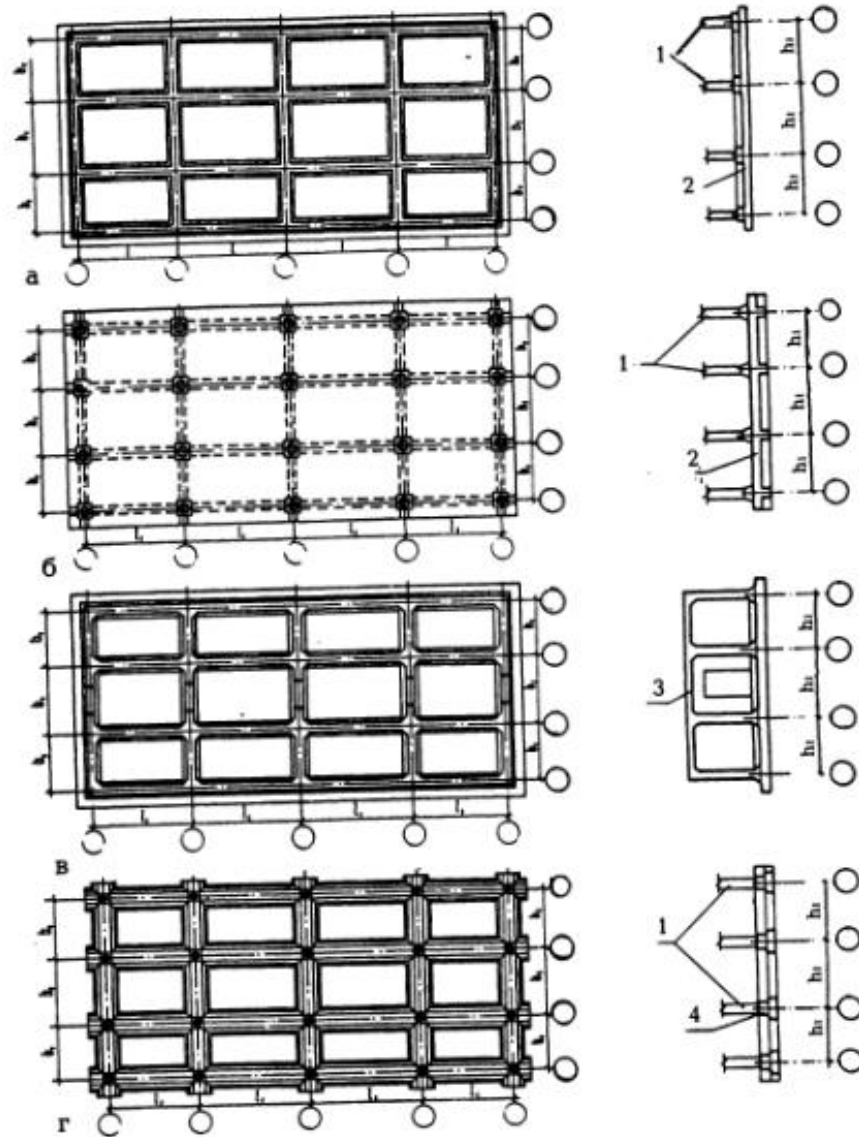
Плитные фундаменты: а, б - с рёбрами вверх (а) и вниз (б); в - коробчатый; г- перекрёстные ленты; 1 - колонна; 2 - фундаментная плита; 3 - коробчатый фундамент; 4 - перекрёстные фундаментные ленты
